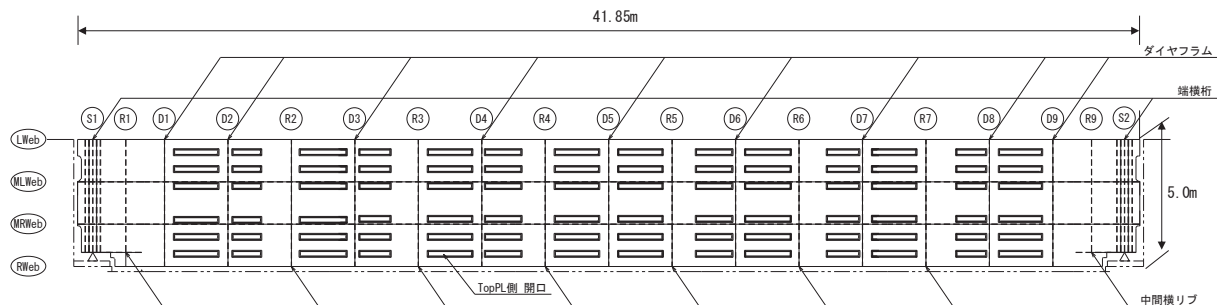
(2) 鋼製遮水壁 (鋼桁 1) 平面図
